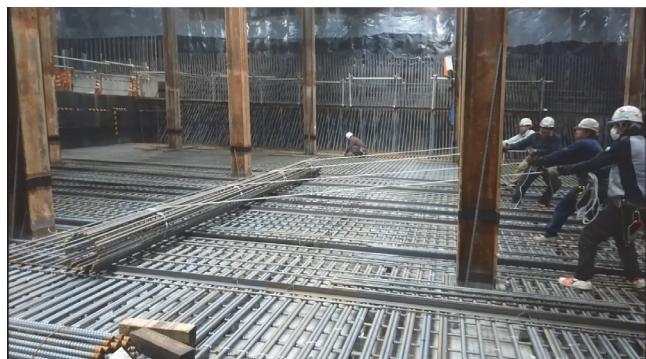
ボックスカルバートの底版の下筋での引張展開式工法の施工状況
